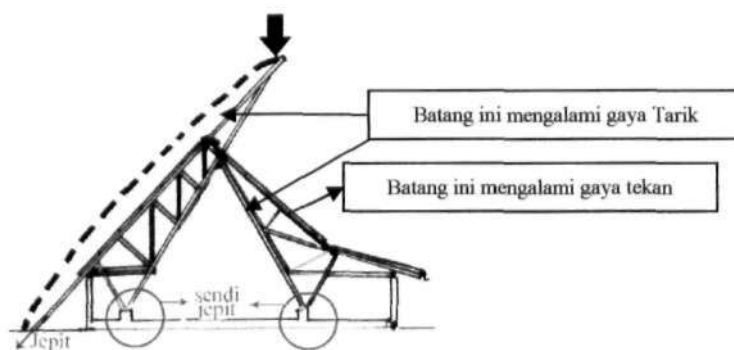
Potongan Melintang dan Potongan Membujur Bangunan
